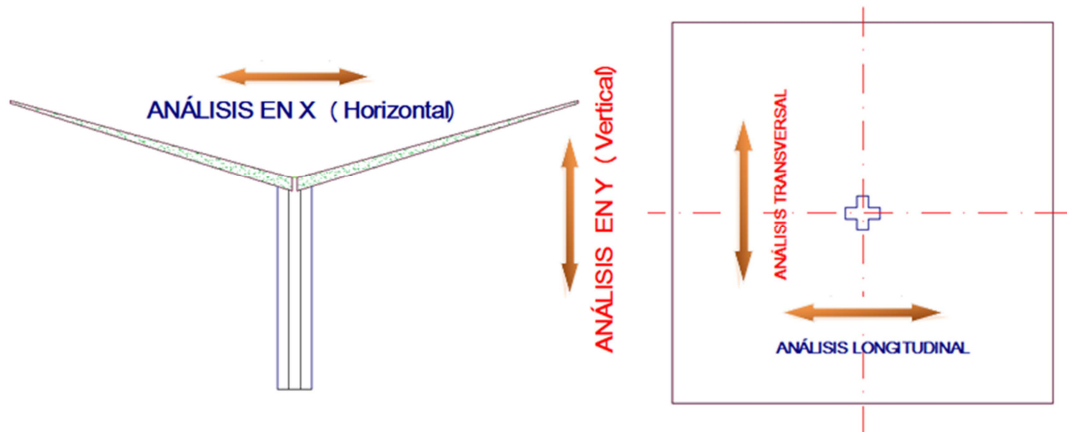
Vista en corte y en planta de columna cruz y cubierta parabólica
